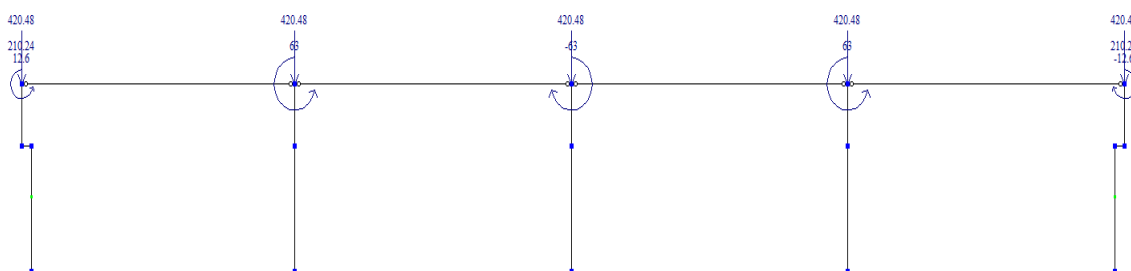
Розрахункова схема будівлі від снігового навантаження
